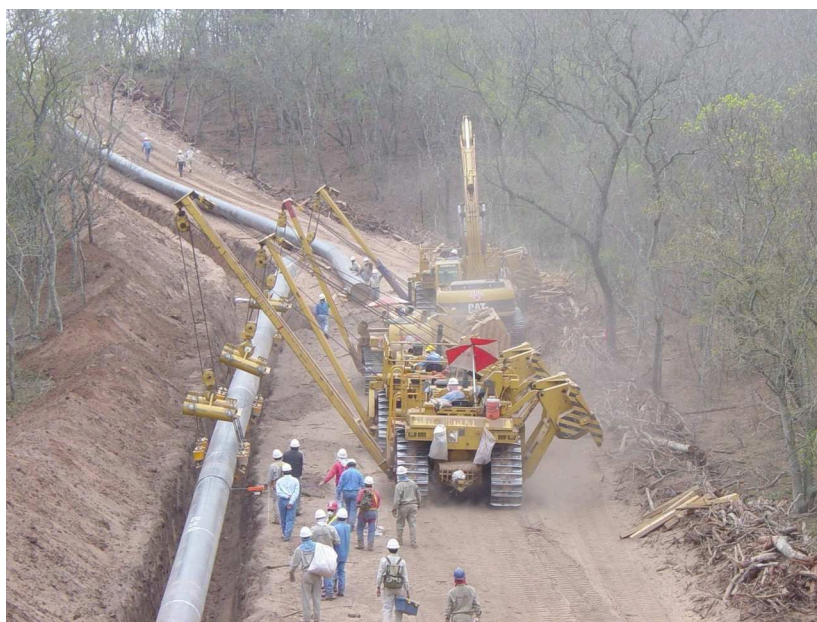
Construção de um gasoduto terrestre (fonte: autor)
